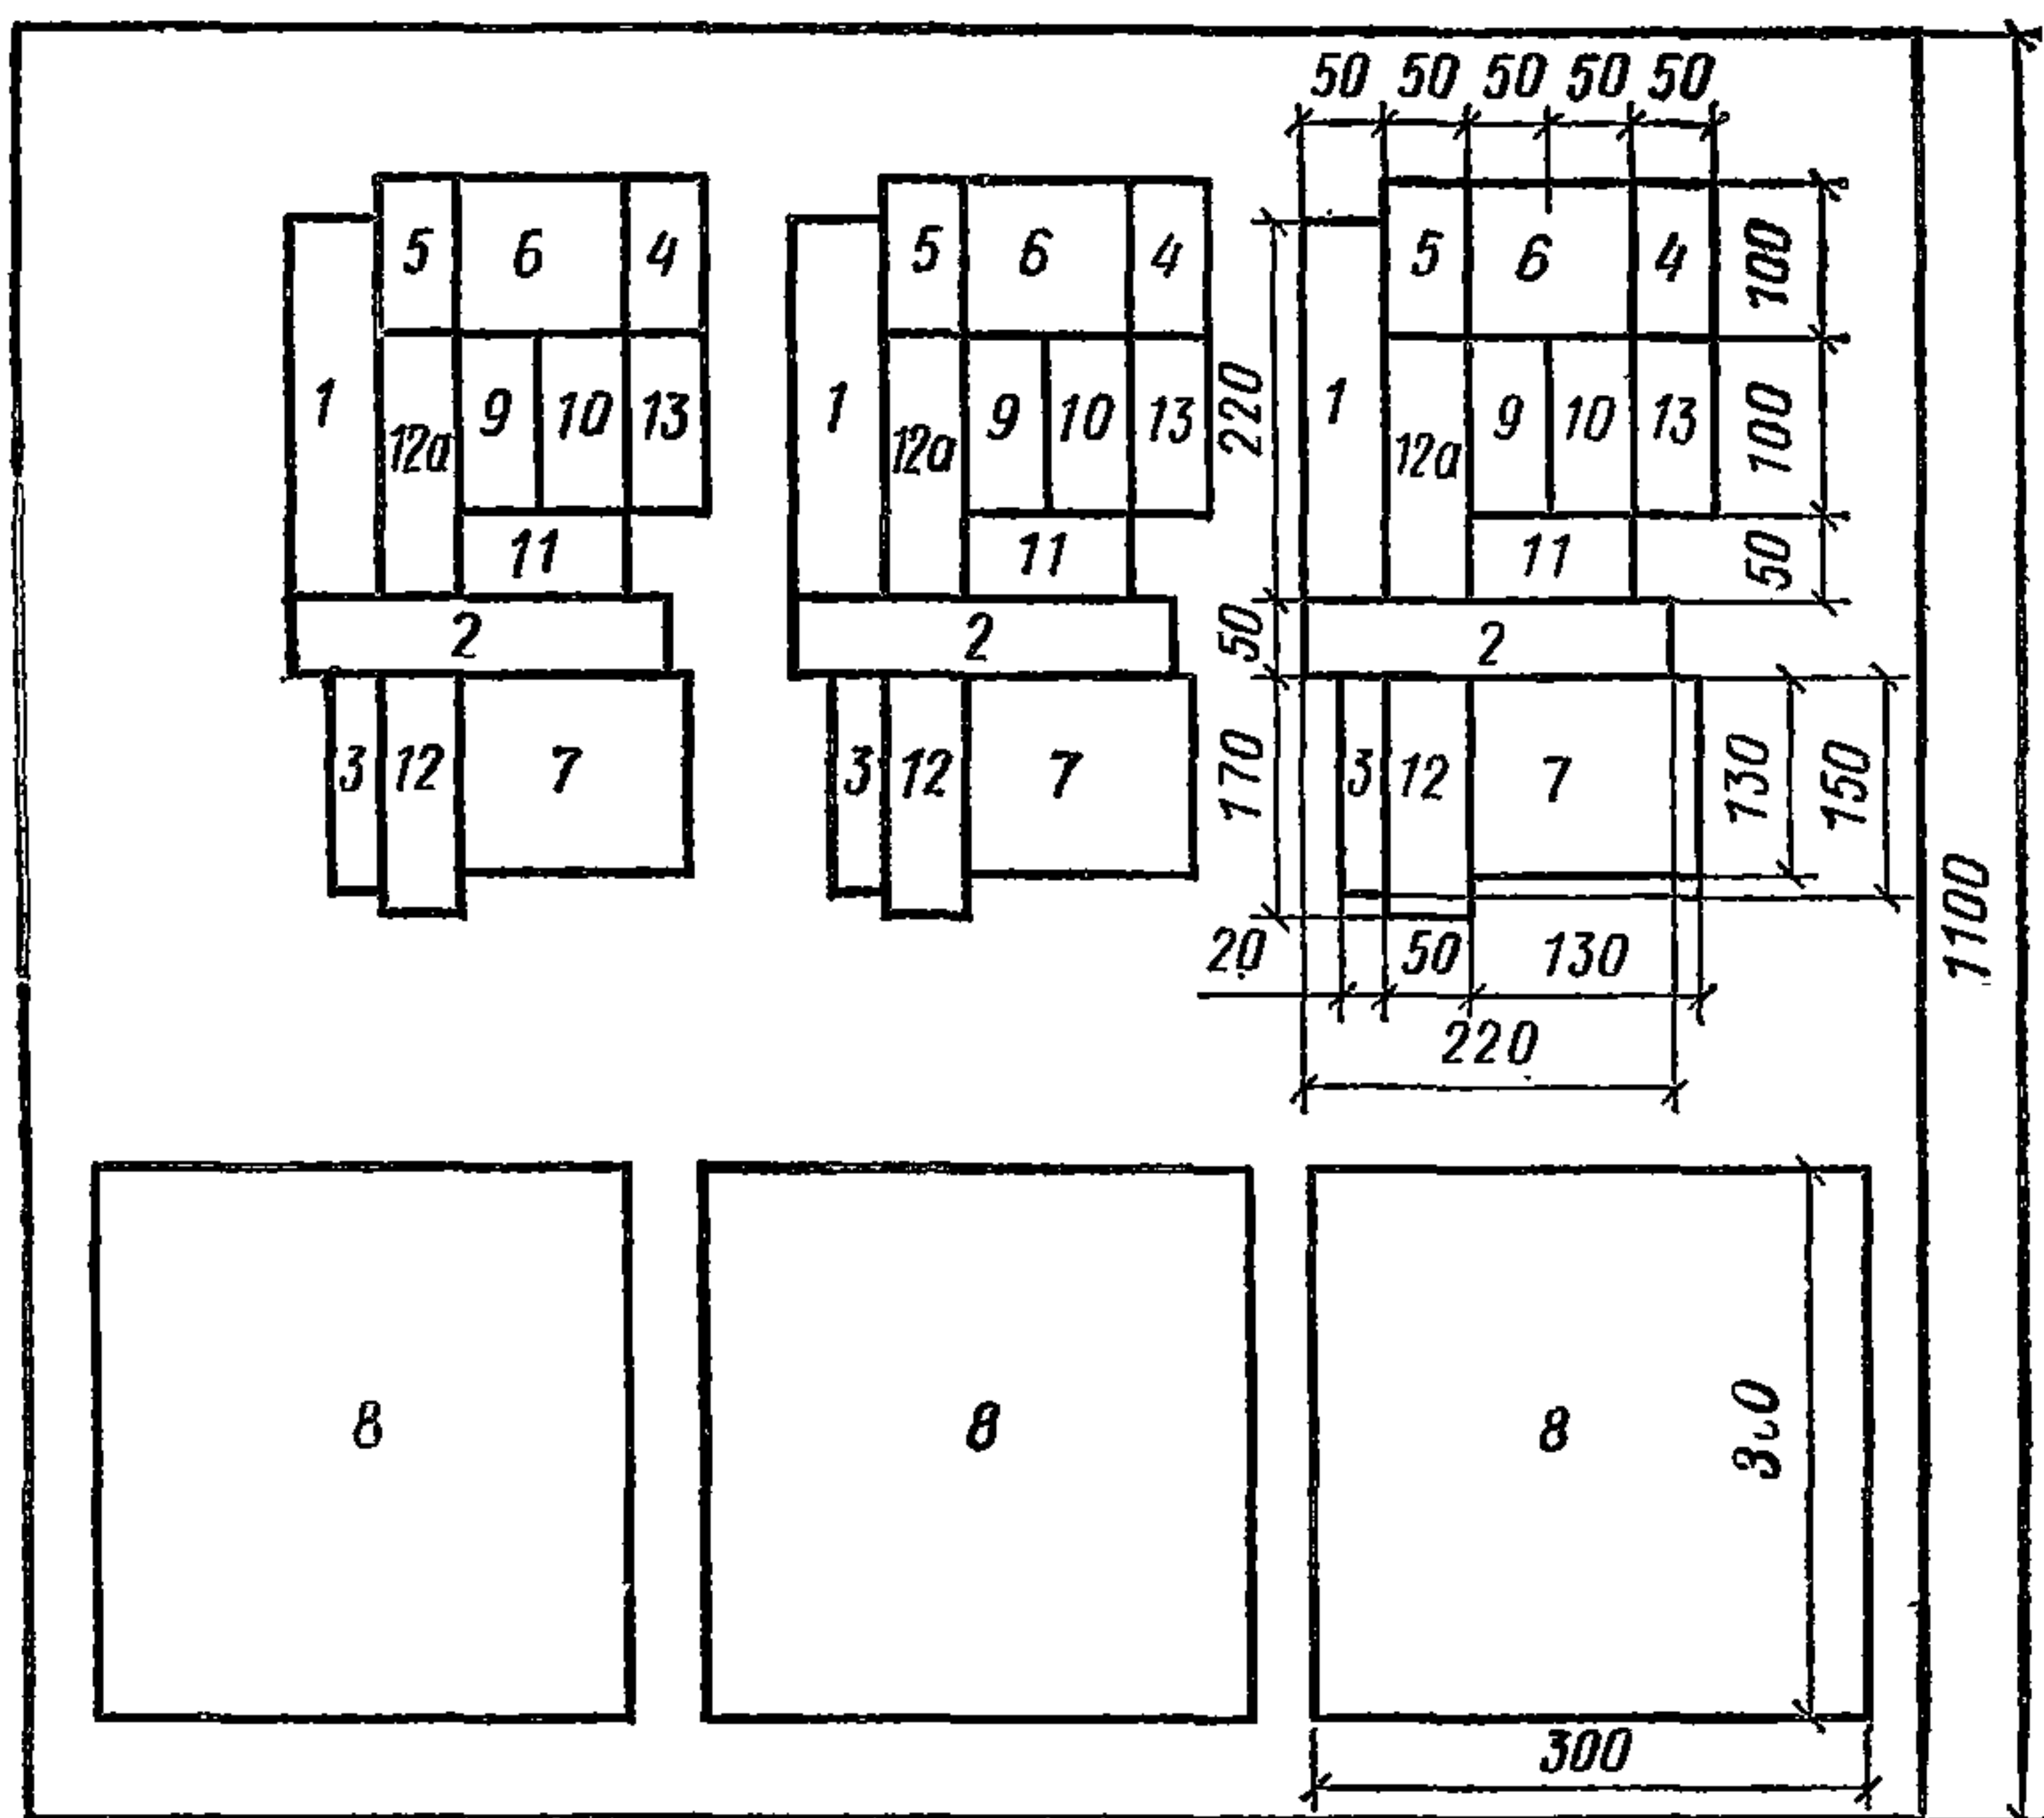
Схема вырубki из кровли шурфов на образцы для испытаний на водопоглощение (№ 6), водонепроницаемость (№ 7 и № 8) теплостойкость (№ 9) и гибкость (№ 3)
